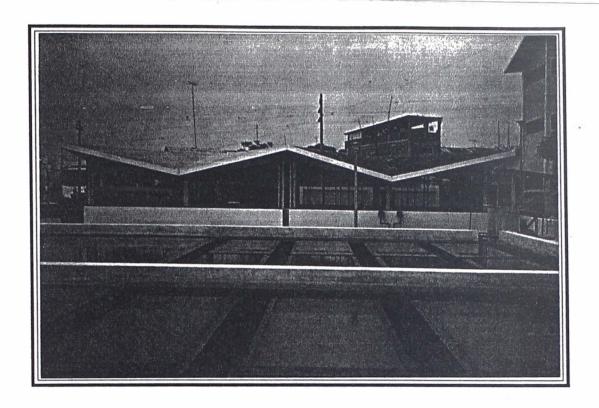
En primer plano se aprecian los SEDIMENTADORES de la Planta Nueva y al fondo la sala de control de válvulas de los filtros.
